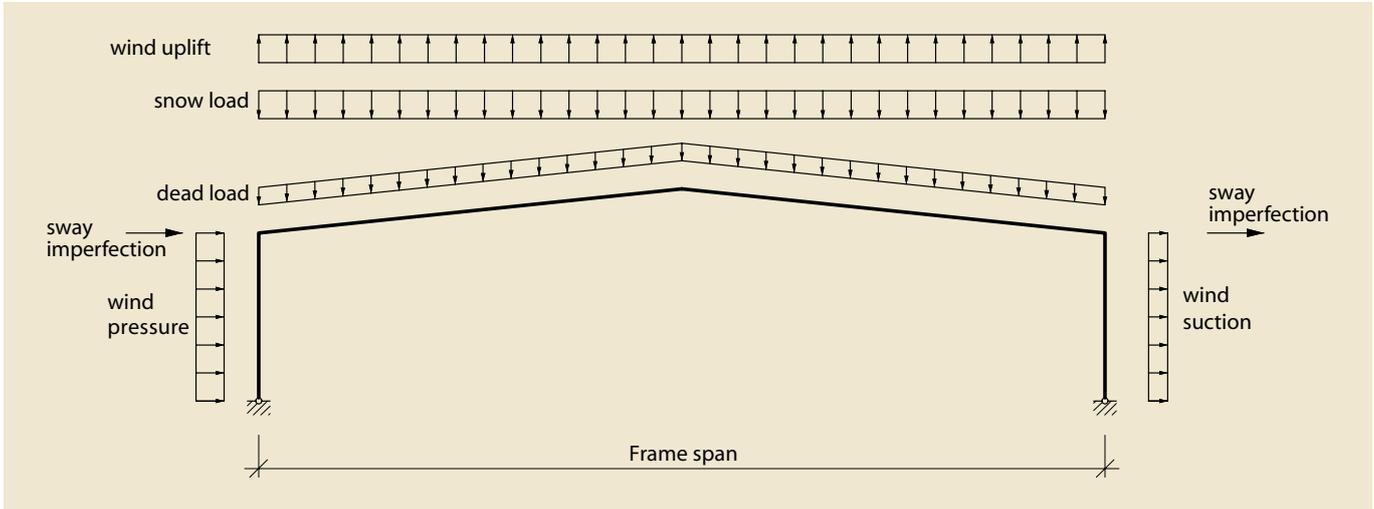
(Arriba) Esquema de carga en una estructura aporticada
